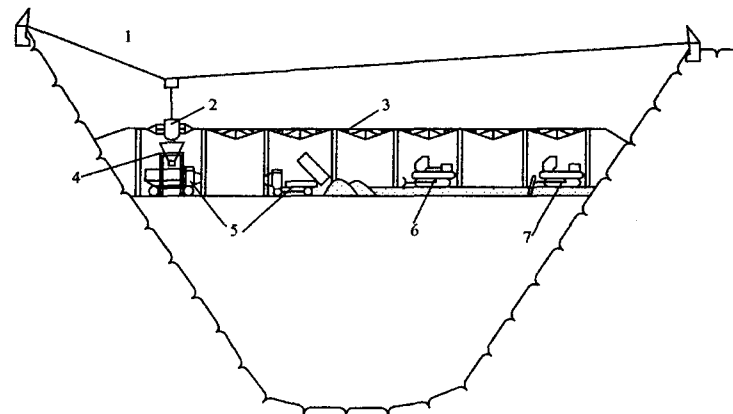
Схема бетонирования плотины Кировского гидроузла на реке Талас:
